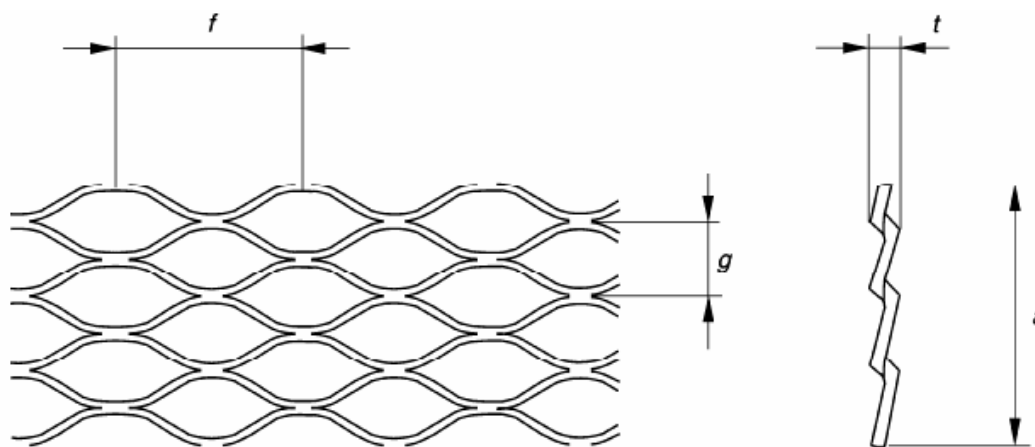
Пример стальной плетеной сетки – вид сверху и вид в разрезе
